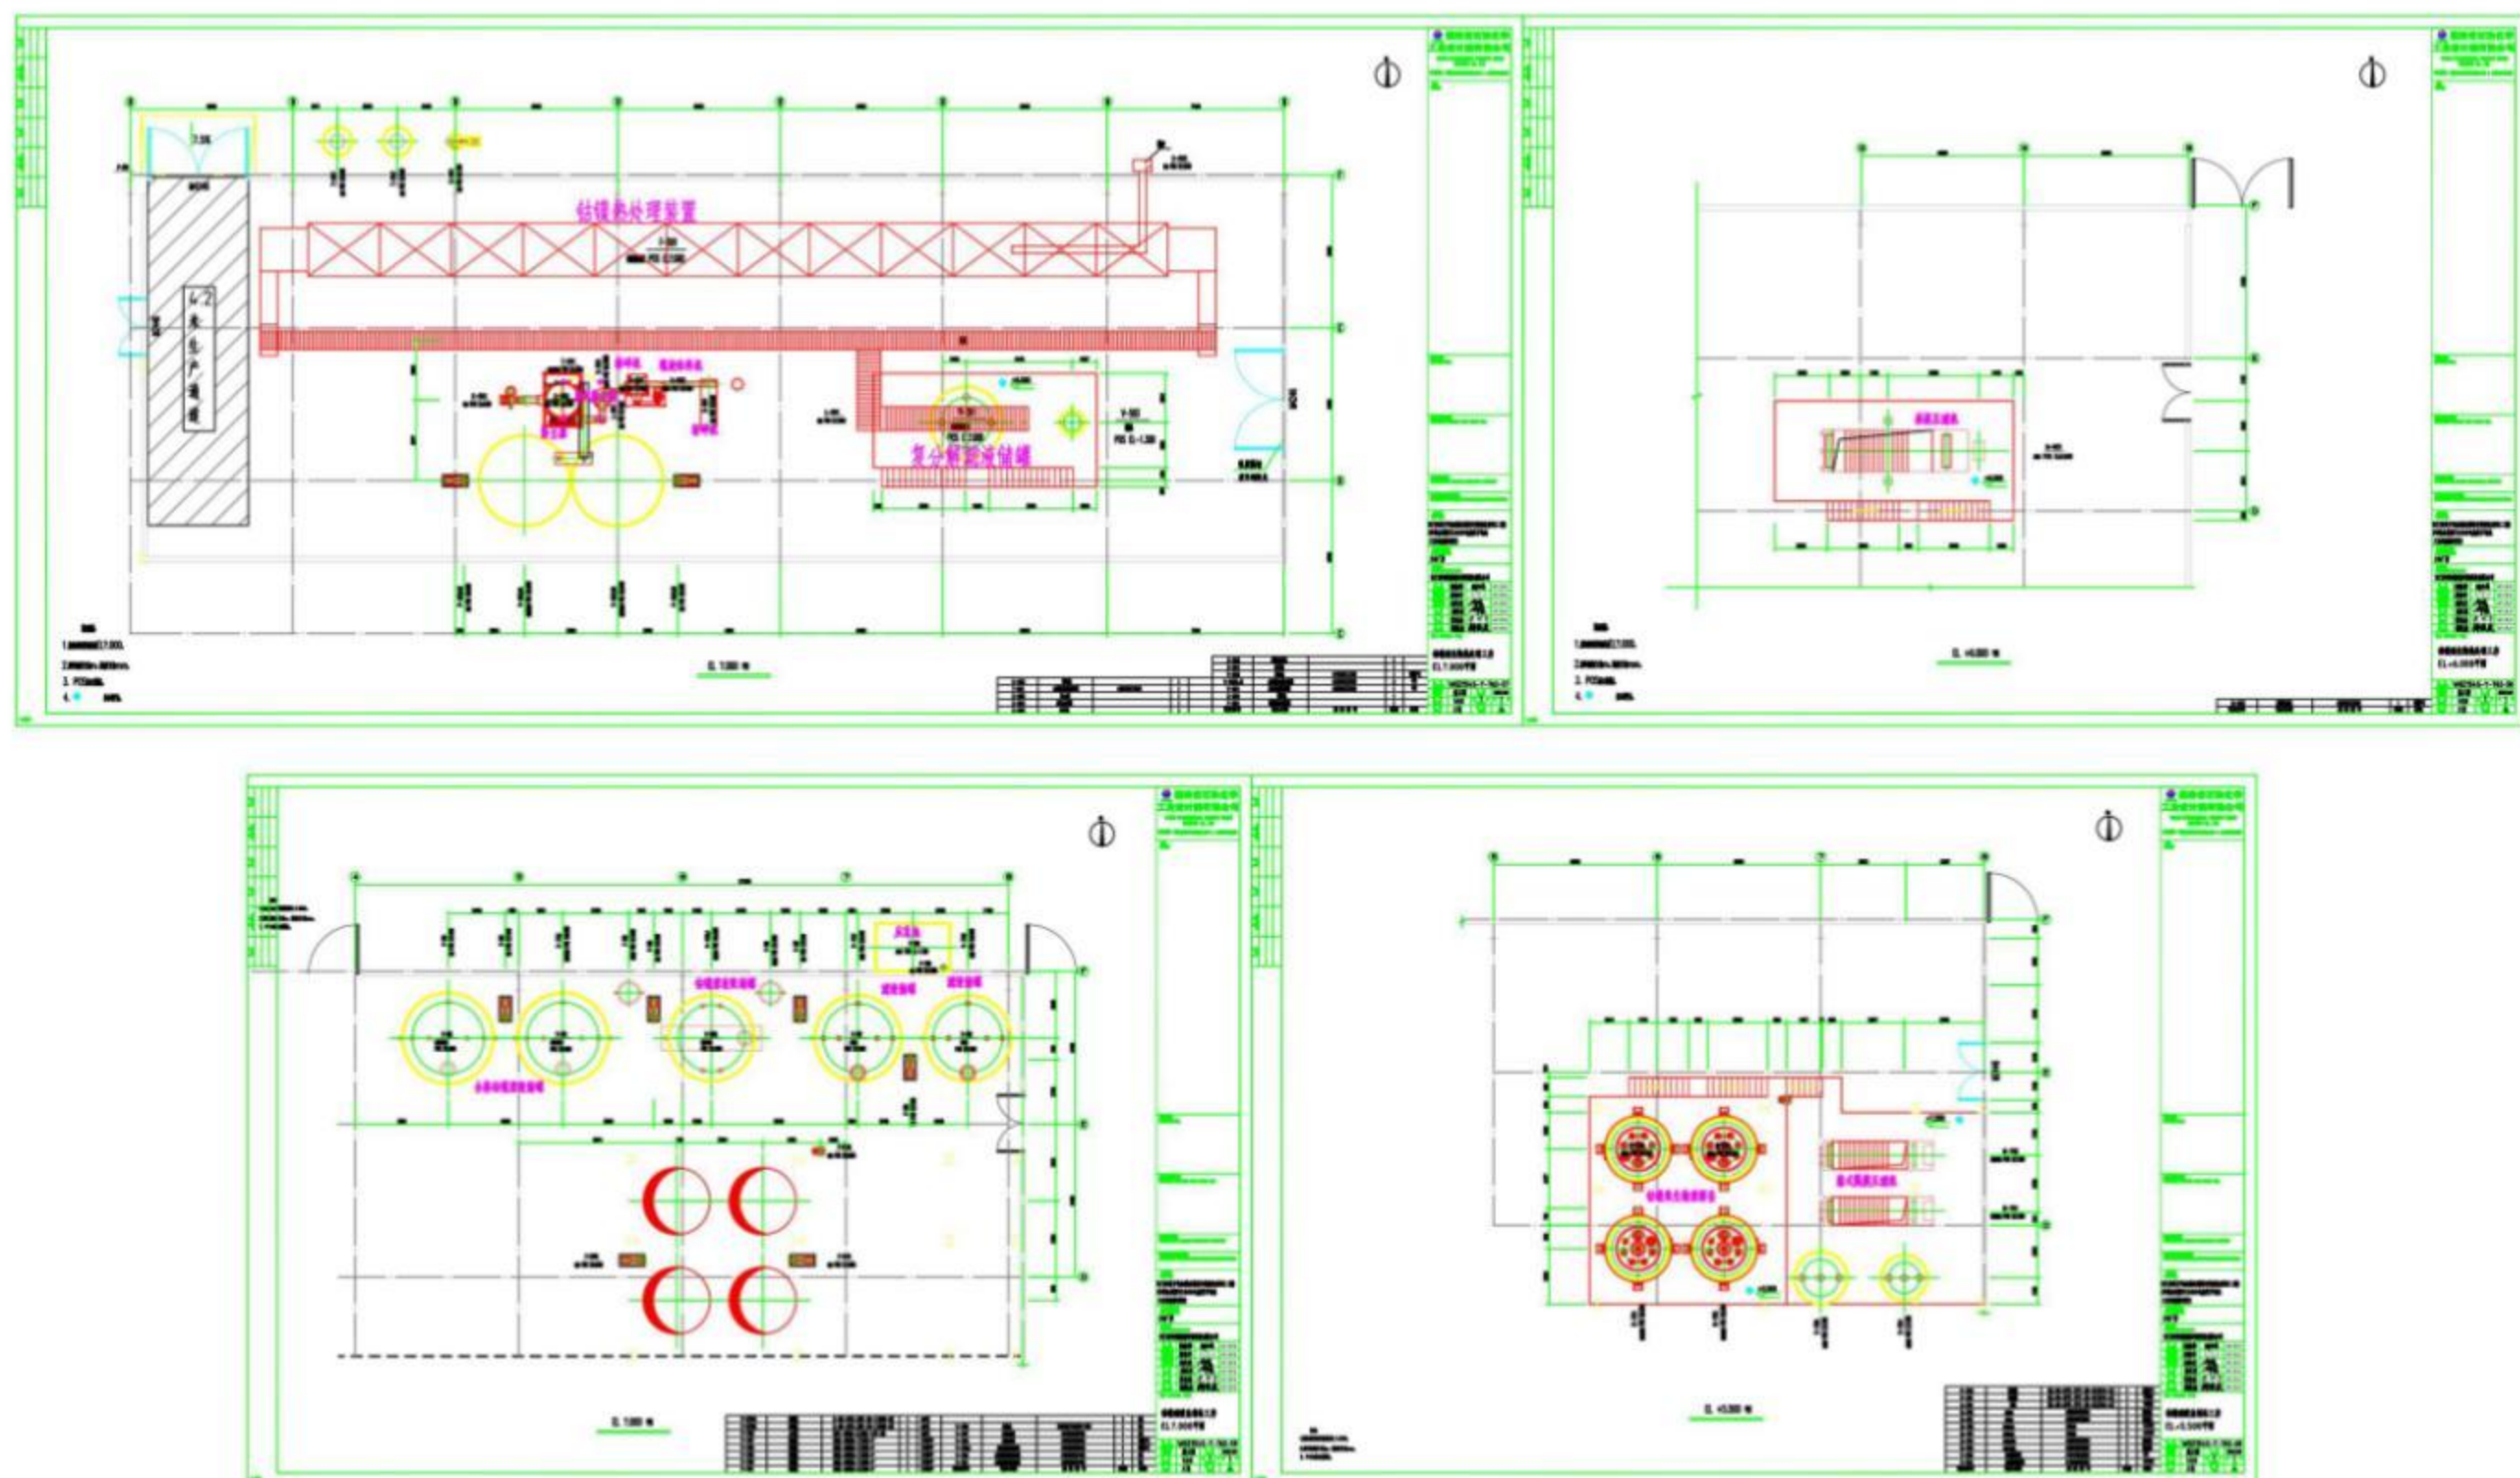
2#厂房-钴镍硫化物热处理区域、钴镍硫酸盐区域平面布置图
